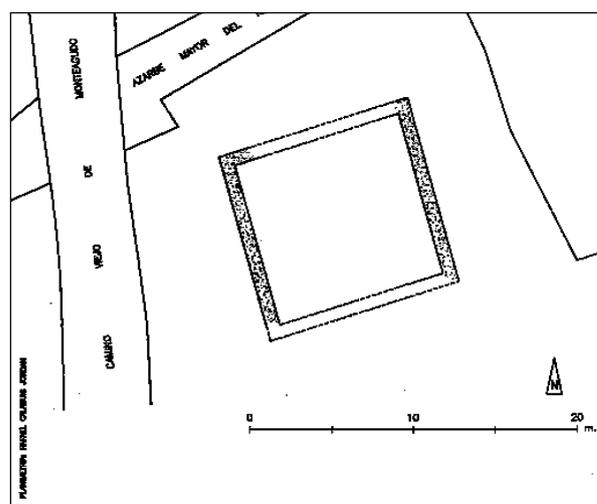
Torre del Batán. Plano de situación. Entorno de la fortificación.
